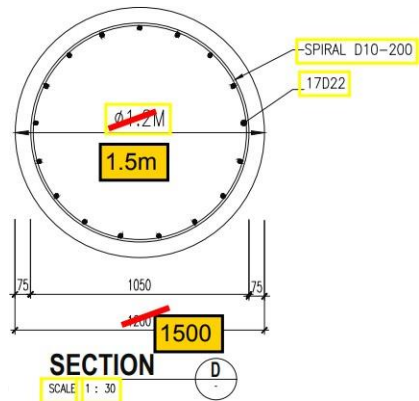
43 Shop drawing detail tulangan bored pile type G section E
